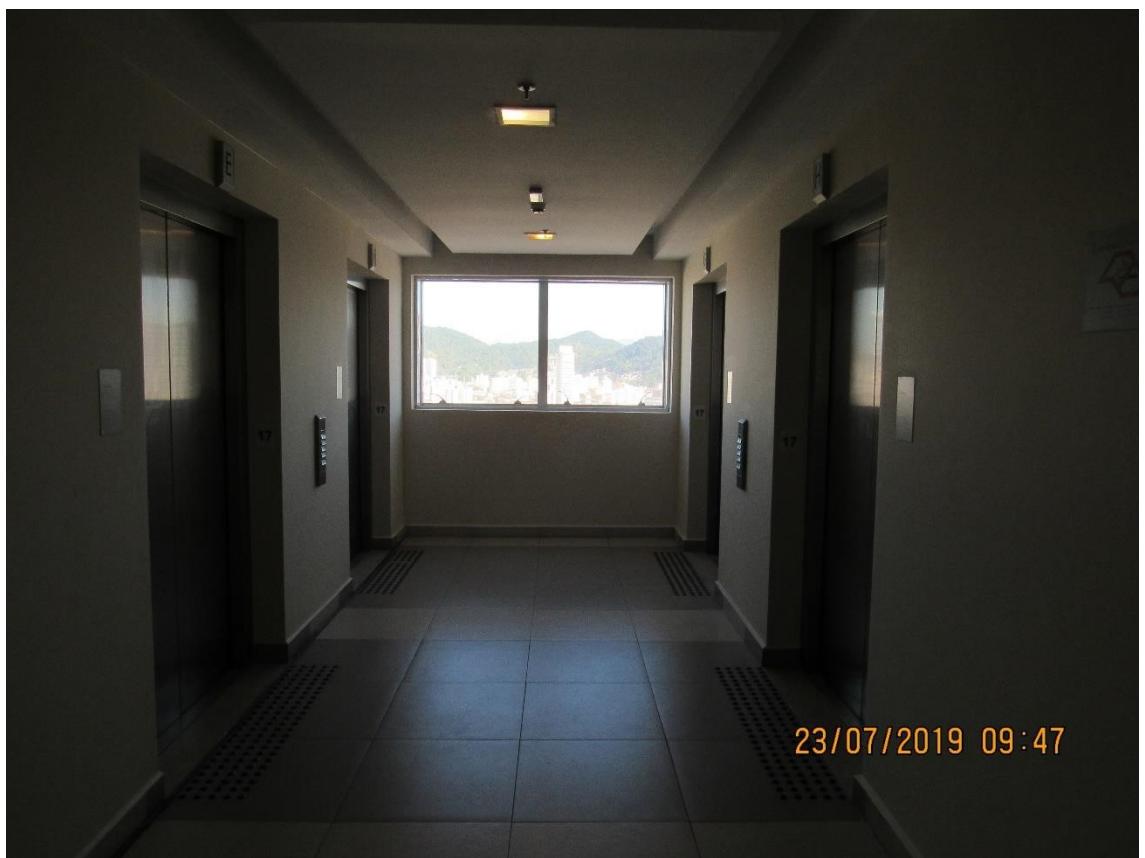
15º pavimento - hall de elevadores padrão – salas comerciais
